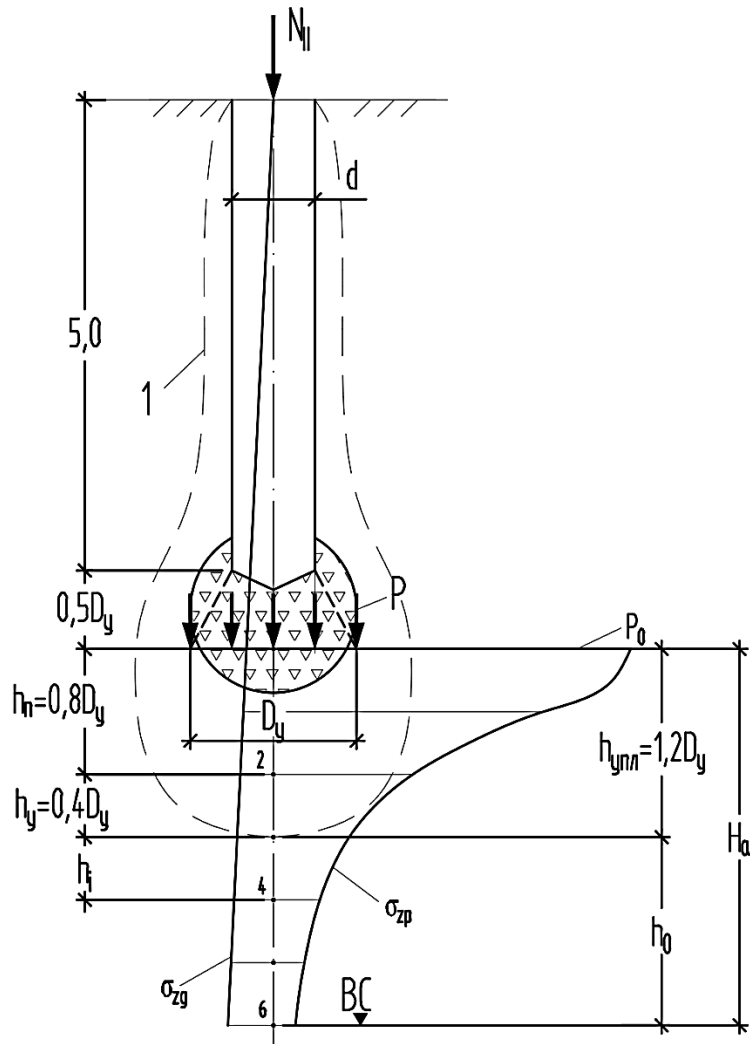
Расчетная схема для определения осадки свай с учетом пластической зоны $h_{п}$, уплотненного грунта $h_{упл}$ и зоны грунта естественного сложения h_0 ; 1 – граница зоны уплотненного грунта
